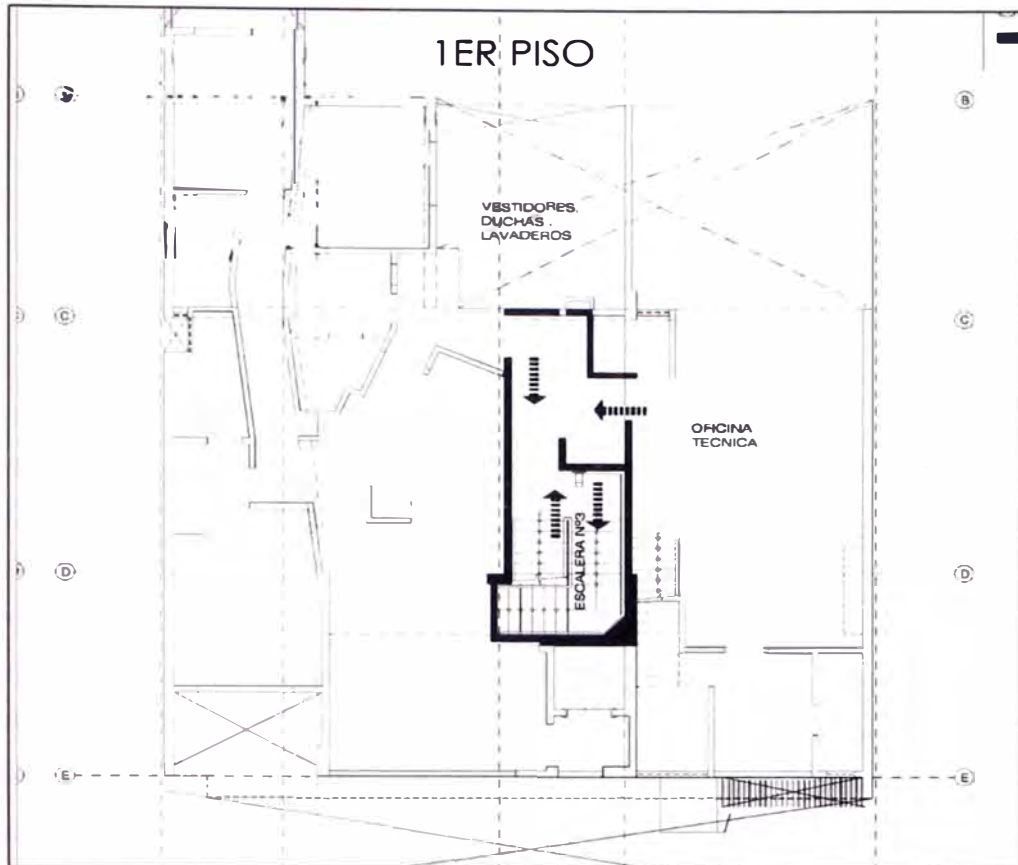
Layout del primer piso del proyecto "Alameda" (segunda etapa)
